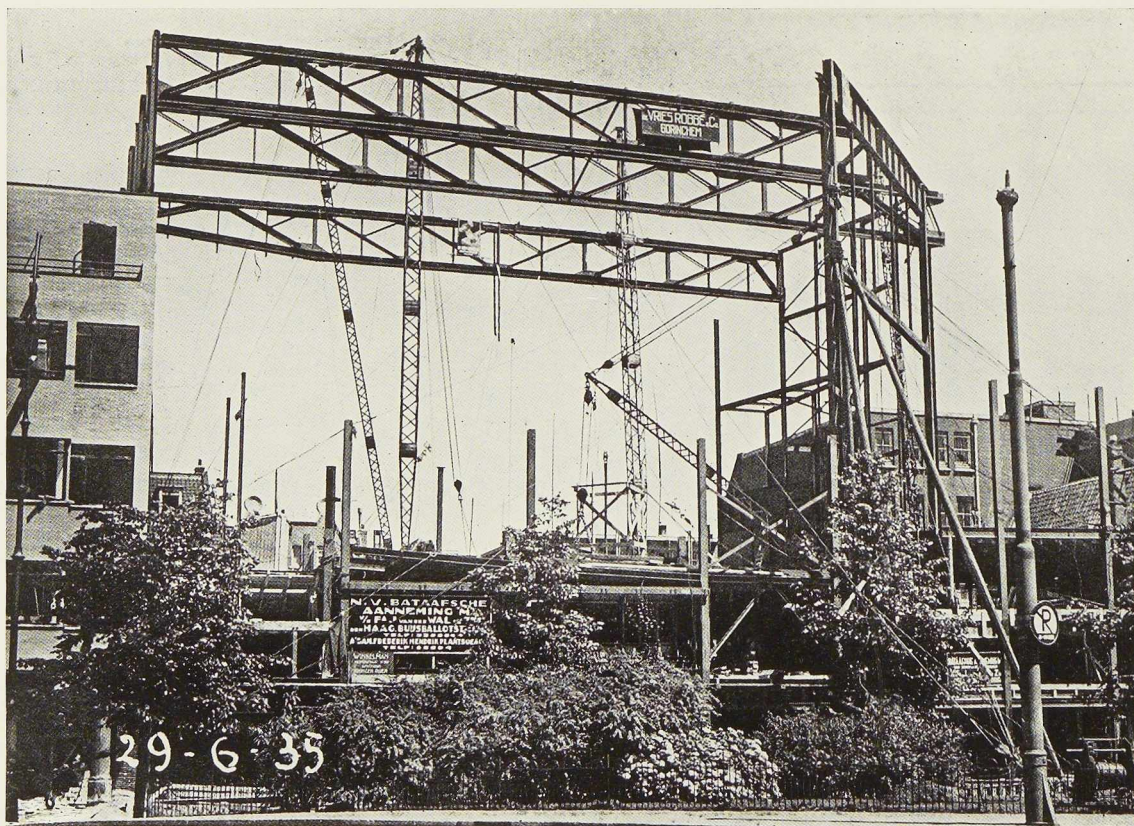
Montage des fermes de la toiture à l'abri de laquelle s'achèvera le montage de la construction. (Cliché « Staal »)
